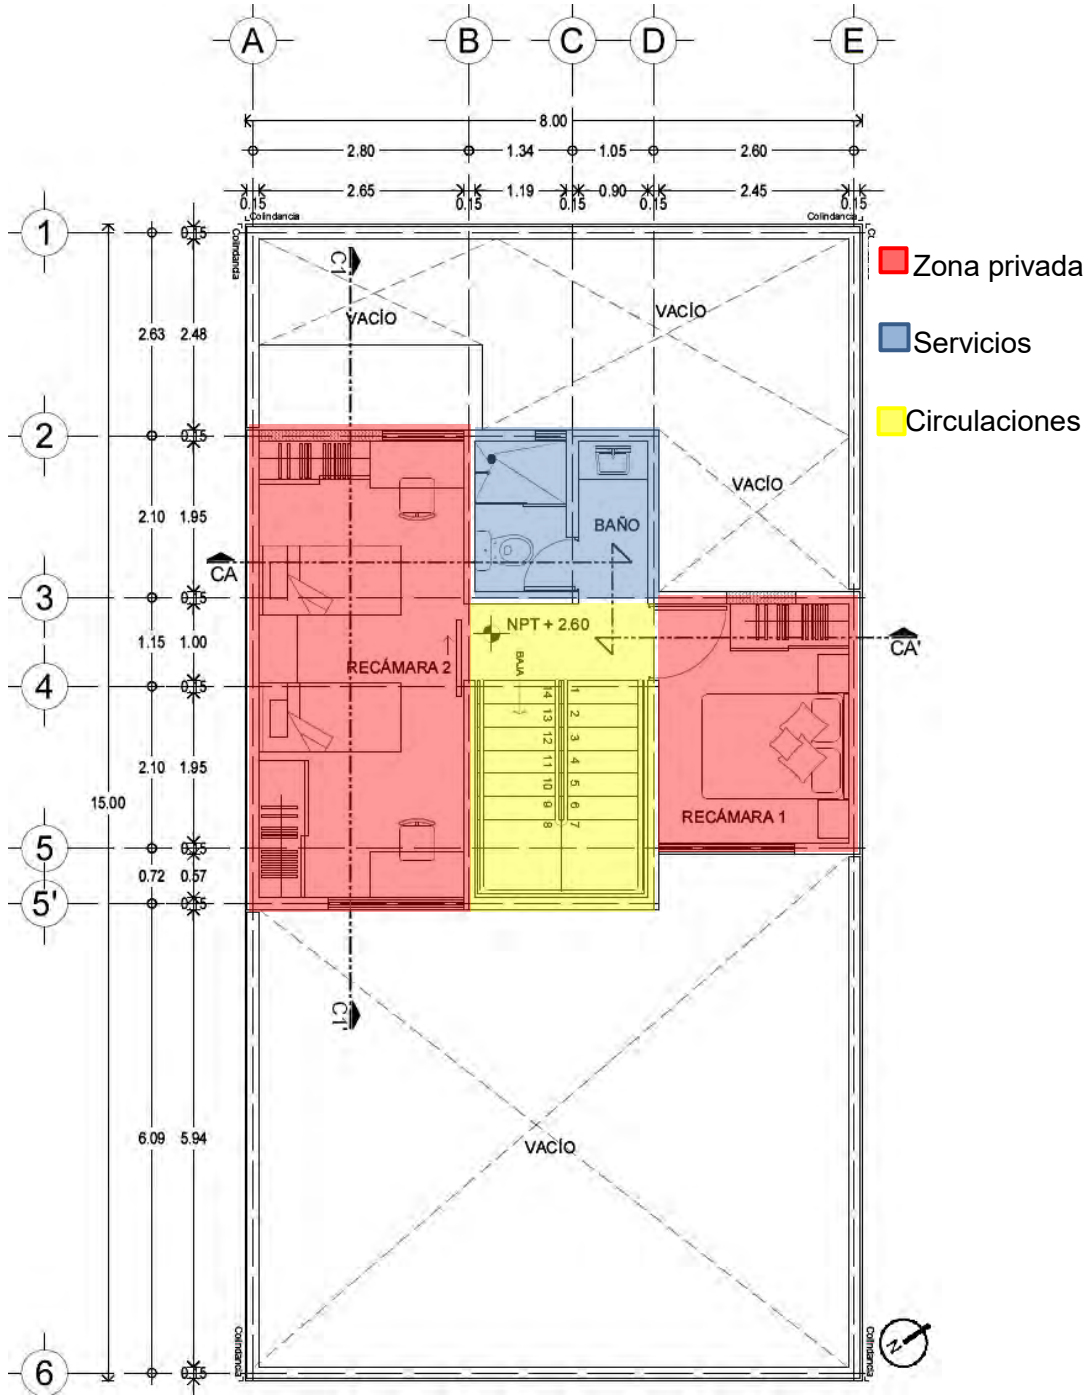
Planta arquitectónica de prototipo de vivienda A3. Segunda etapa, primer nivel.
